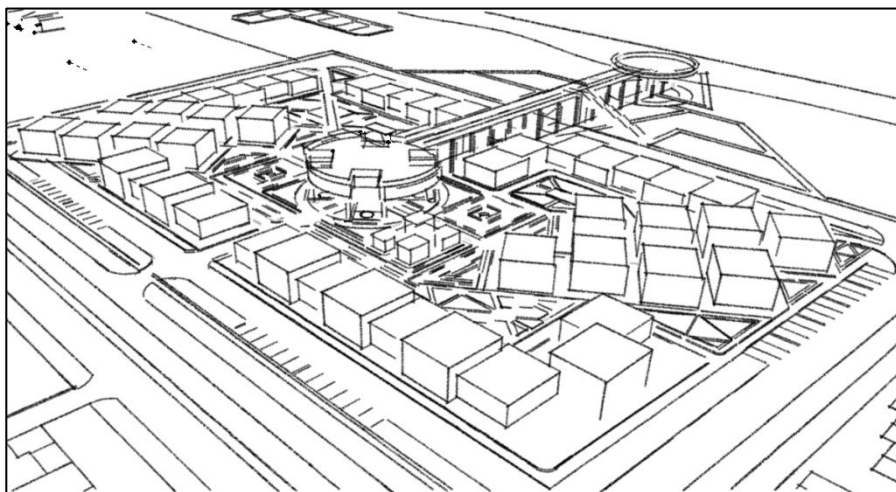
Présentation tridimensionnelle de plan d'aménagement. (Source: Auteur, 2023)
